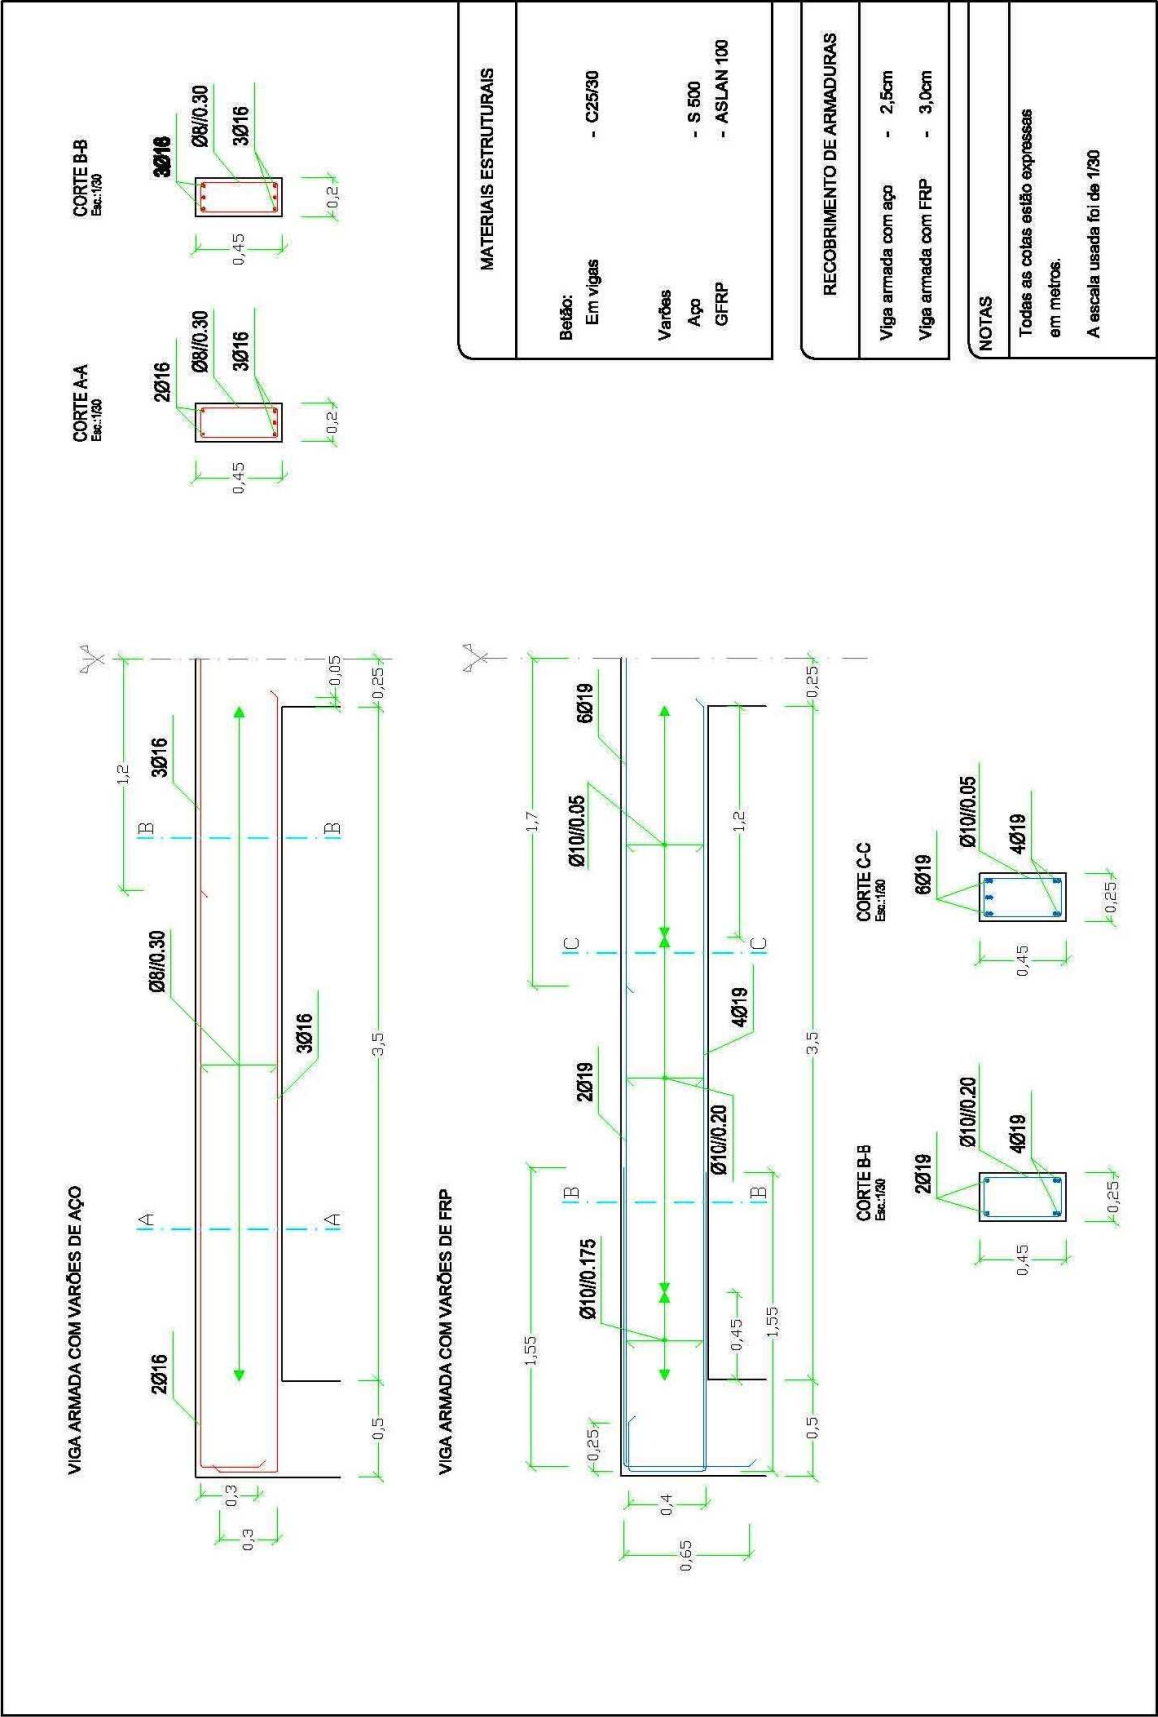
Desenhos das vigas armadas com aço e FRP.
